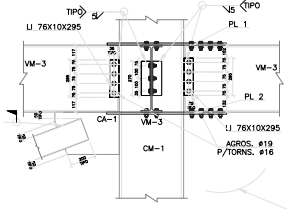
Detalle constructivo de columna Hollow Structural Sections (HSS).
